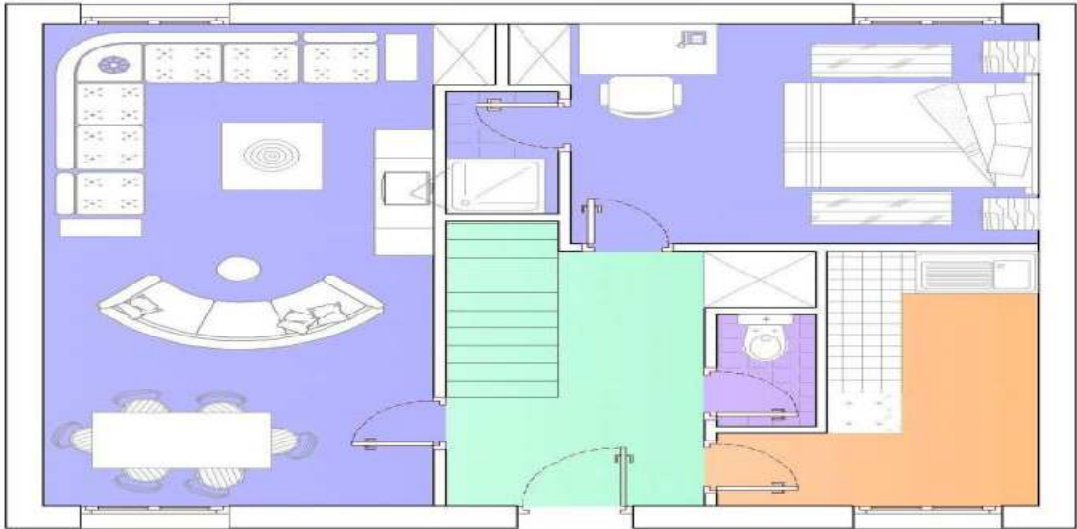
plan du Rez-De Chaussée réalisé avec Autocad.
